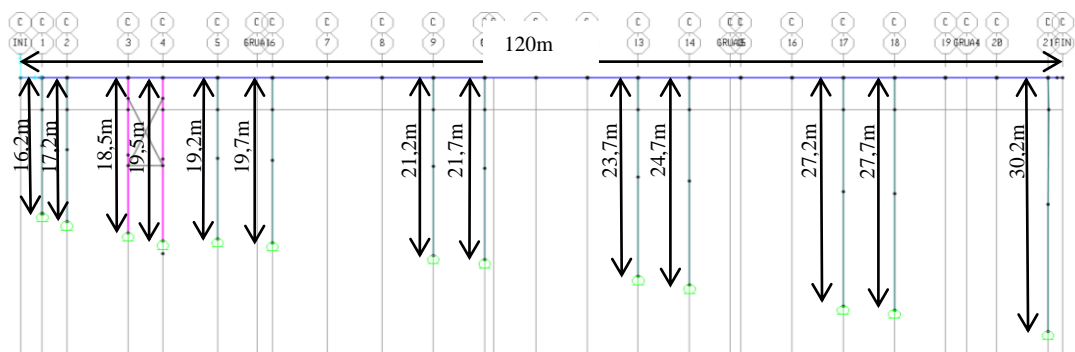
Vista en elevación del plano C de geometría, paralelo a plano X-Vertical'.
